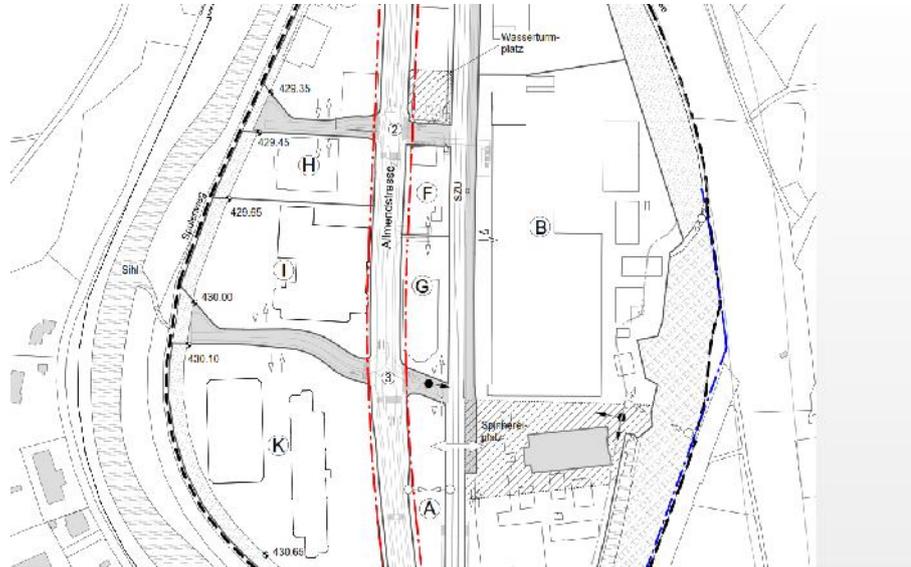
Gestaltungsplan Manegg, Ausschnitt aus dem Situationsplan (Quelle: EBP)
